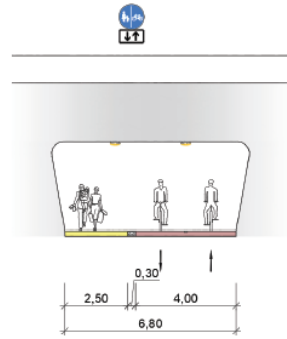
Bahnunterführung (Obere Bahnhofstraße bis Maubacher Straße) – Planung
